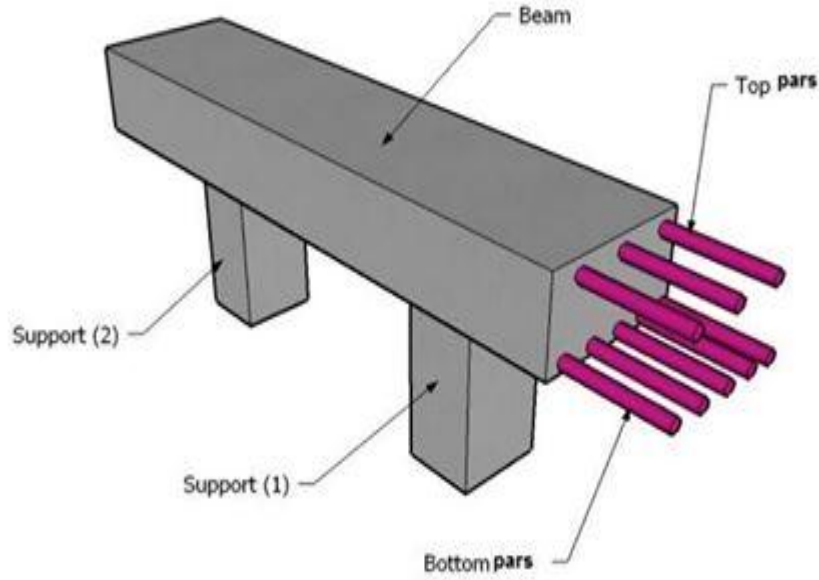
عقدة مصمتة باتجاه واحد.
